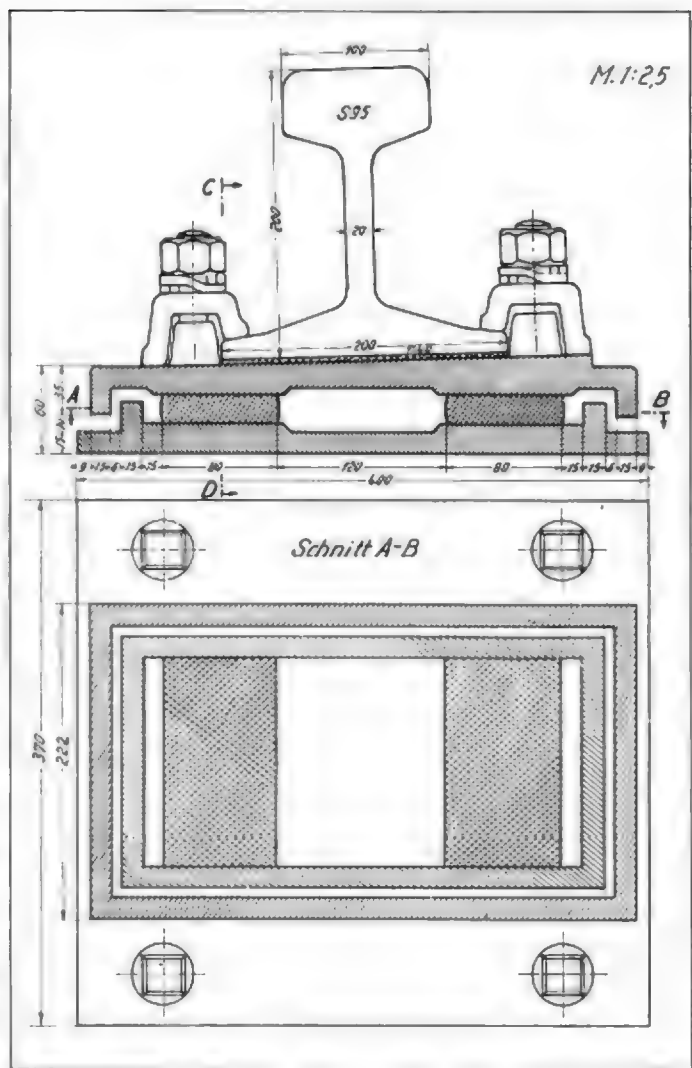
Stahlgummilager nach Rummler mit Gummilamellen.
